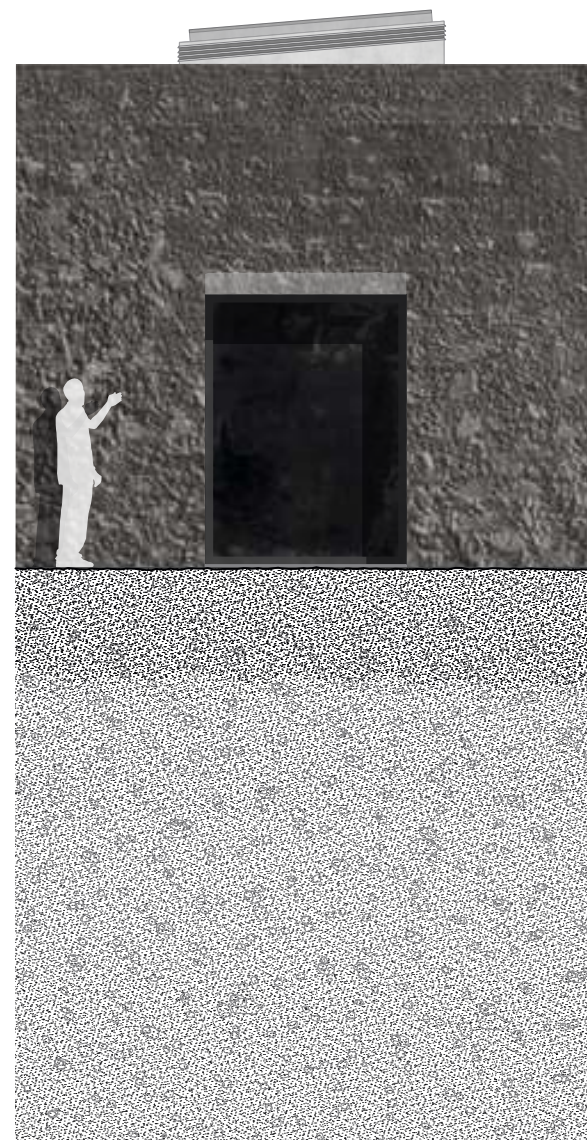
Teilansicht der Nordfassade, Fenster zur Tankhalle
